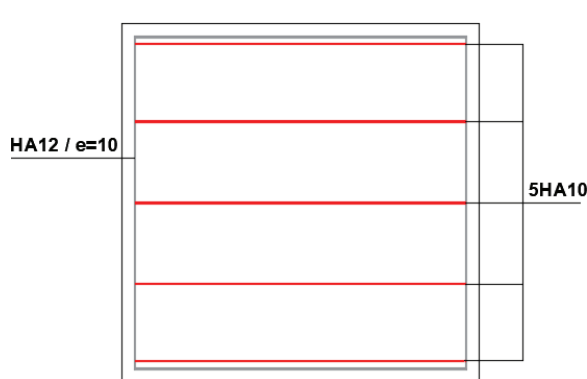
Croquis de ferrailage du dés d'appuis vue en plan (inférieure).
